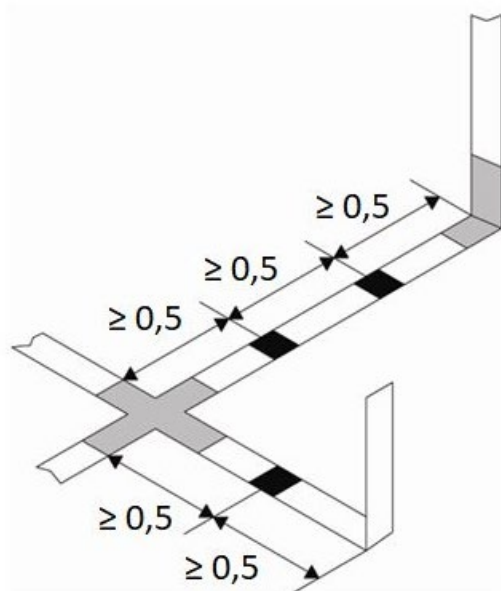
Схема сваривания гидроизоляционных лент
